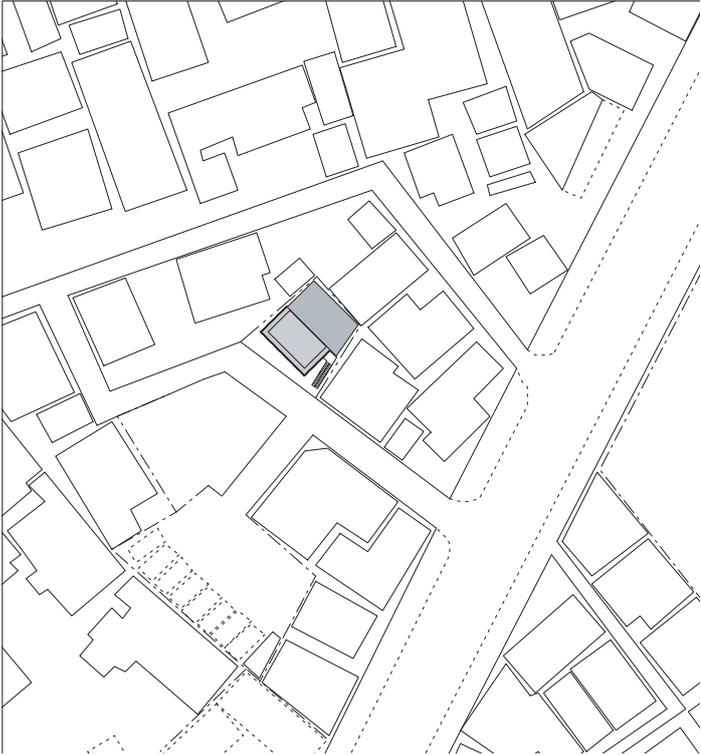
Lageplan und Grundriss, 1.Stock, Crystal Bricks
